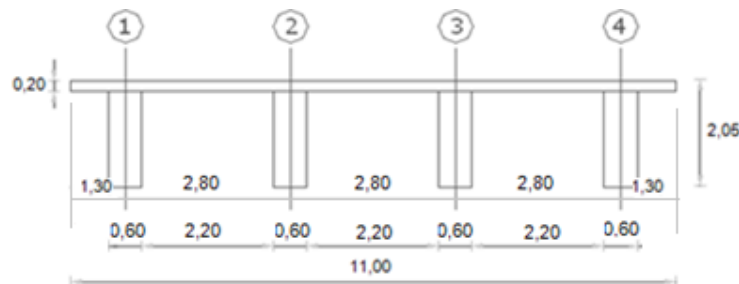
Sección transversal del puente de vigas de hormigón pretensado y tablero de hormigón armado (alternativa "B")
